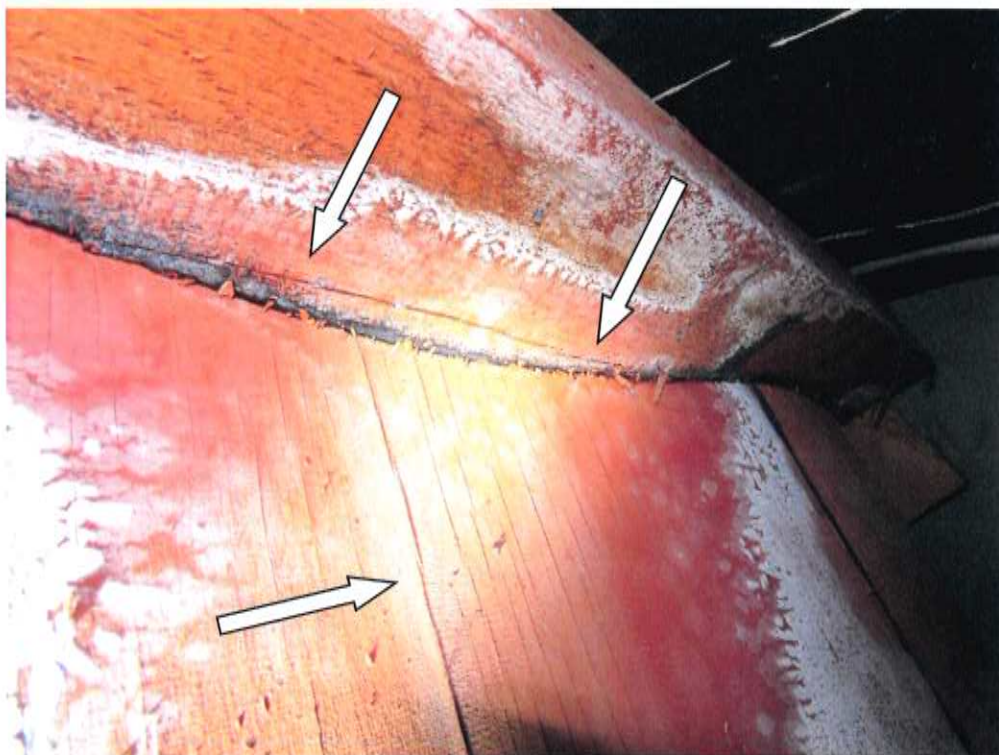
Holz-Wellstegträger: Detail flächige Aussinterungen / Salze auf den Holzoberflächen (exemplarisch) und Risse im Obergurt und Steg
